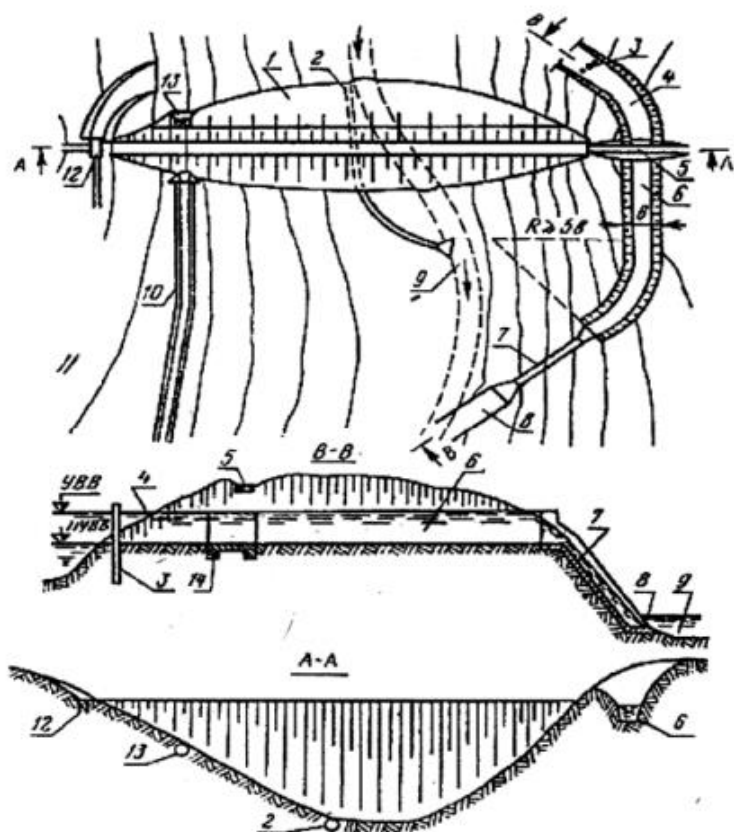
Водохранилищный гидроузел: 1 – грунтовая плотина; 2 – водоспуск; 3 – льдорезная свайная стенка; 4 – отводящий канал; 5 – мост; 6 – сбросной канал; 7 – быстроток; 8 – сопрягающий канал; 9 – тальвег; 10 – магистральный канал; 11 – лиманный канал; 12 – водозабор; 13 – водовыпуск; 14 – водосливной порог
